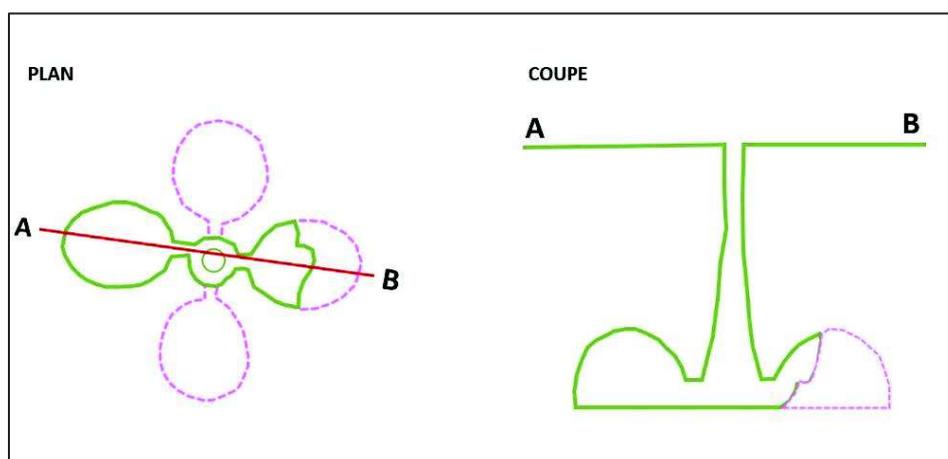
Illustration d'une marnière en plan (à droite) et en coupe (à gauche)
